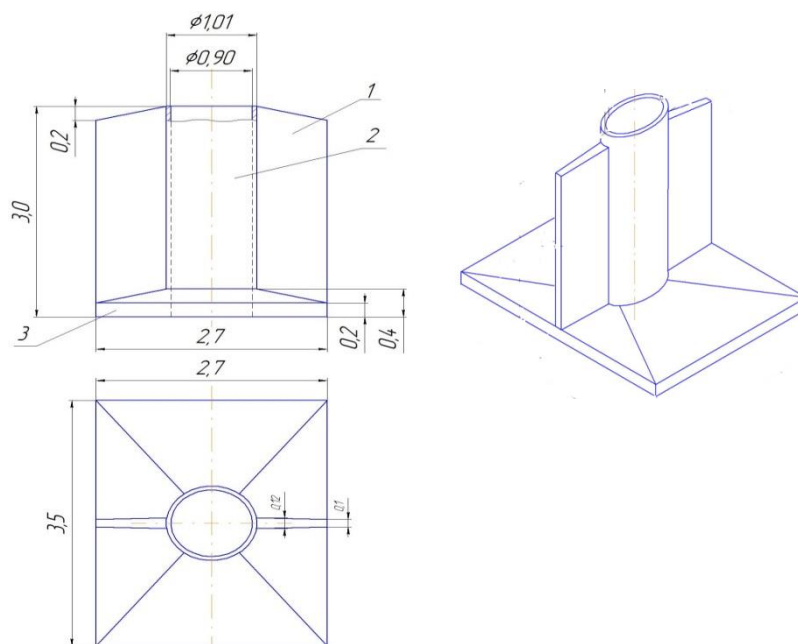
Фундамент для свободностоящих железобетонных опор
